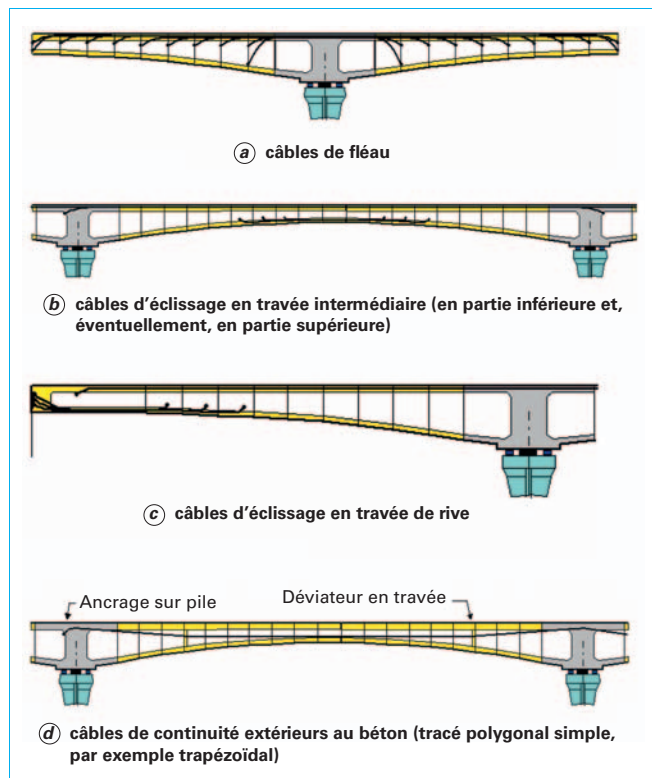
Principes de câblage des ponts modernes construits en encorbellement
